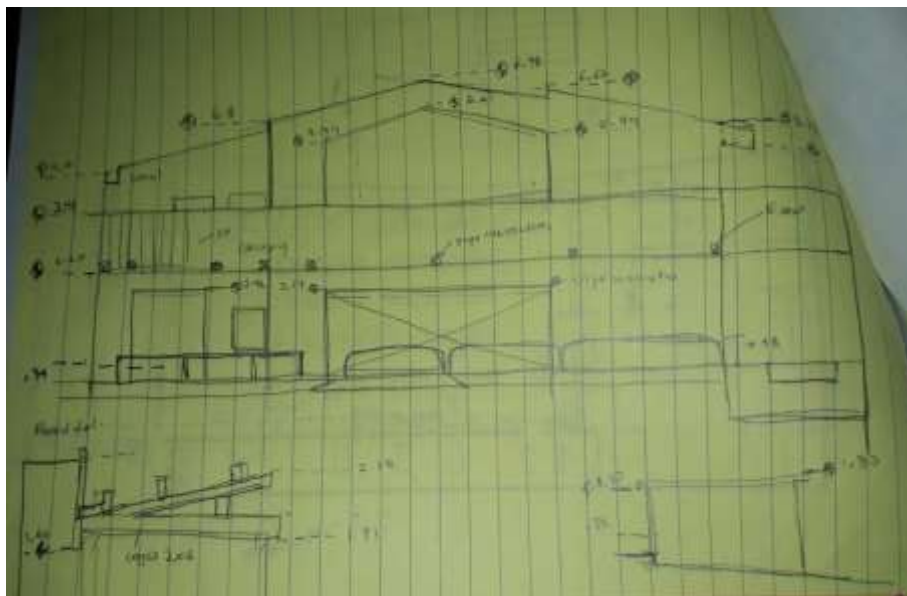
Levantamiento de fachada de la tienda .fuente Elaboración Propia.
